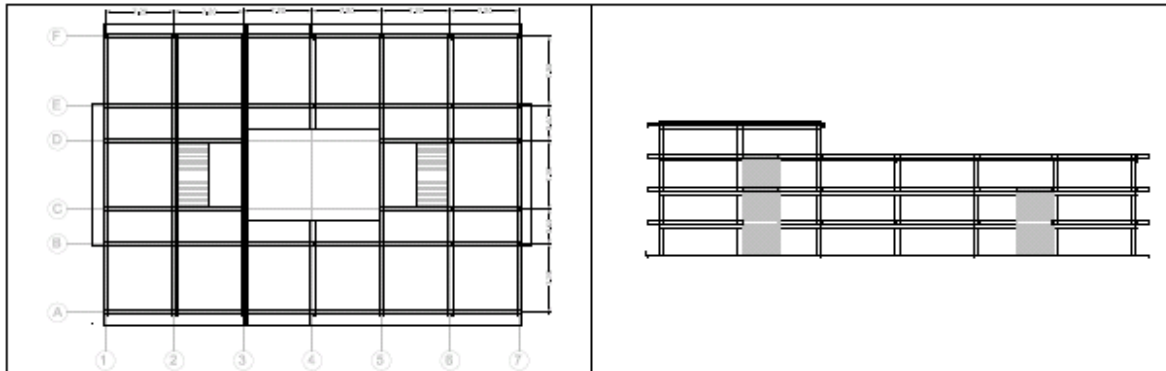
Plano de planta (izquierda) y pórtico en dirección longitudinal (derecha) (Sosa y Taboada, 2007).
